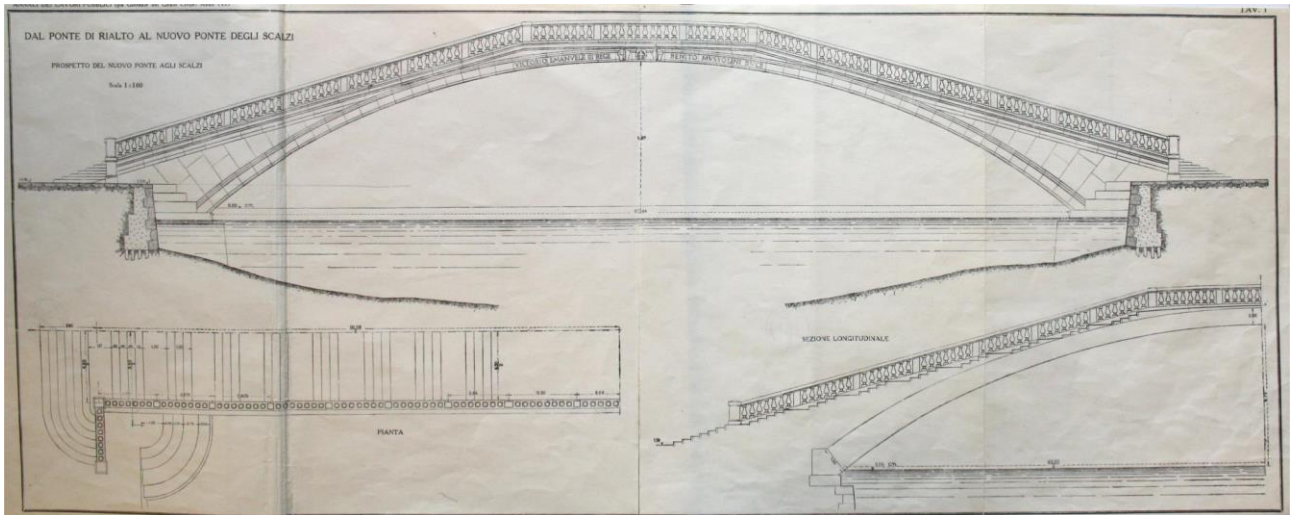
, Prospetto del ponte degli Scalzi (Miozzi, 1935).
